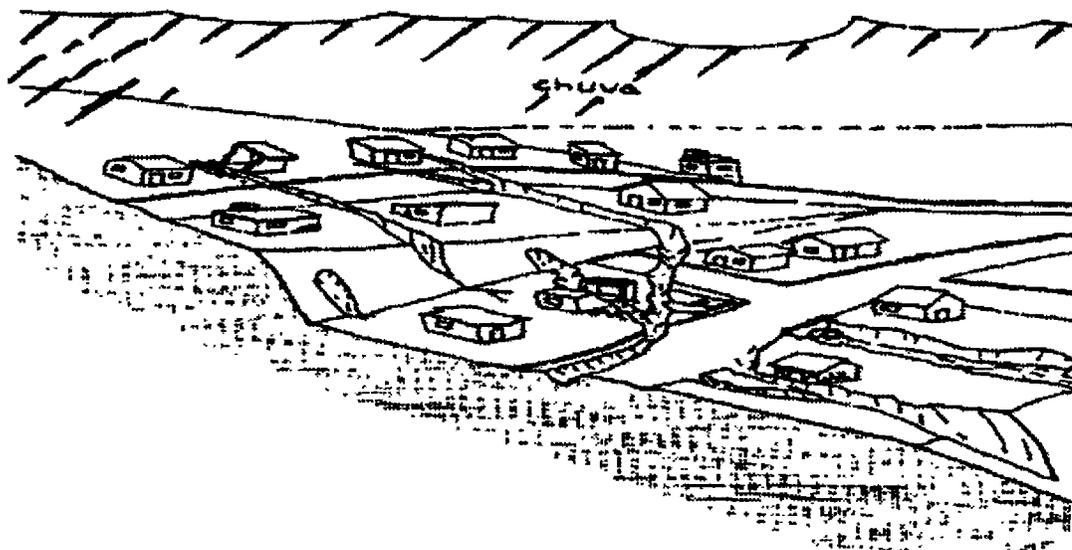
Escorregamento causado por aterro lançado sobre vegetação
